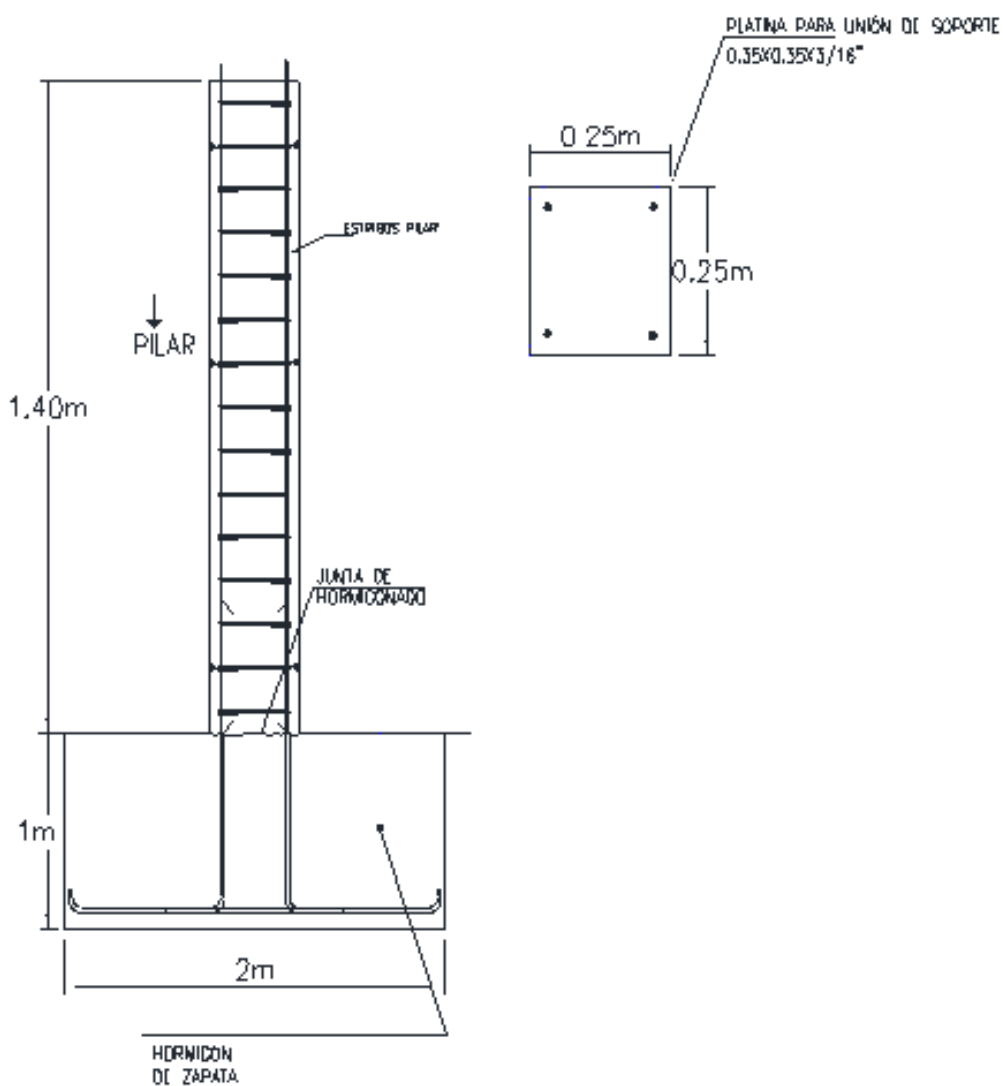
Diseño de la estructura para el soporte de paneles solares.
